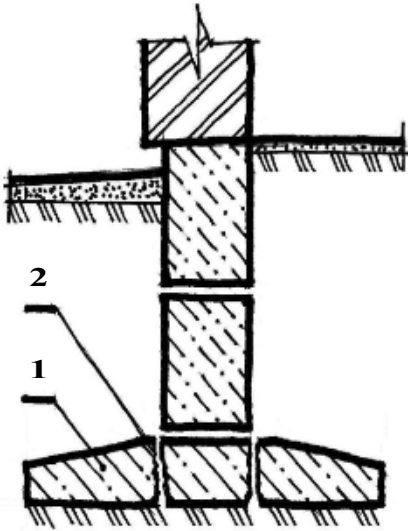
Тріщини в плитній частині фундаменту внаслідок перевантаження фундаменту (надбудова, заміна несучих конструкцій або технологічного обладнання і таке інше), недостатня площа поперечного сечення робочої арматури плити:
